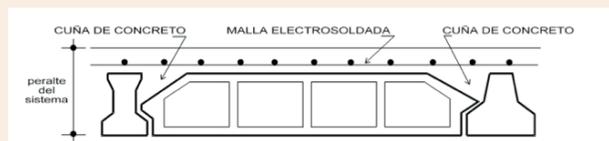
Detalle de Cuña de concreto con vigueta pretensada
